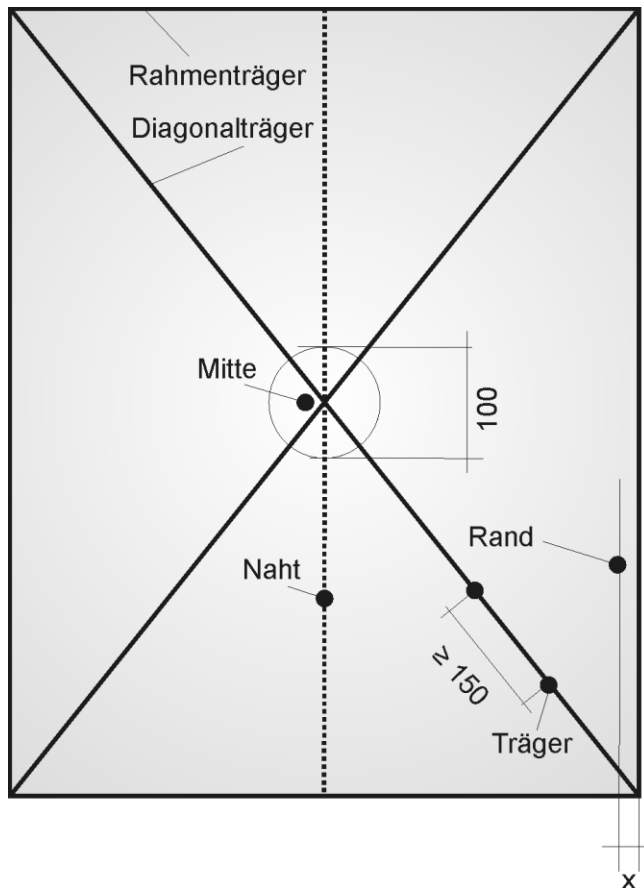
Beschussorte bei zeltähnlichen Bauten im Grundriss (x: 1/2 Projektildurchmesser, Masse in Millimeter)
